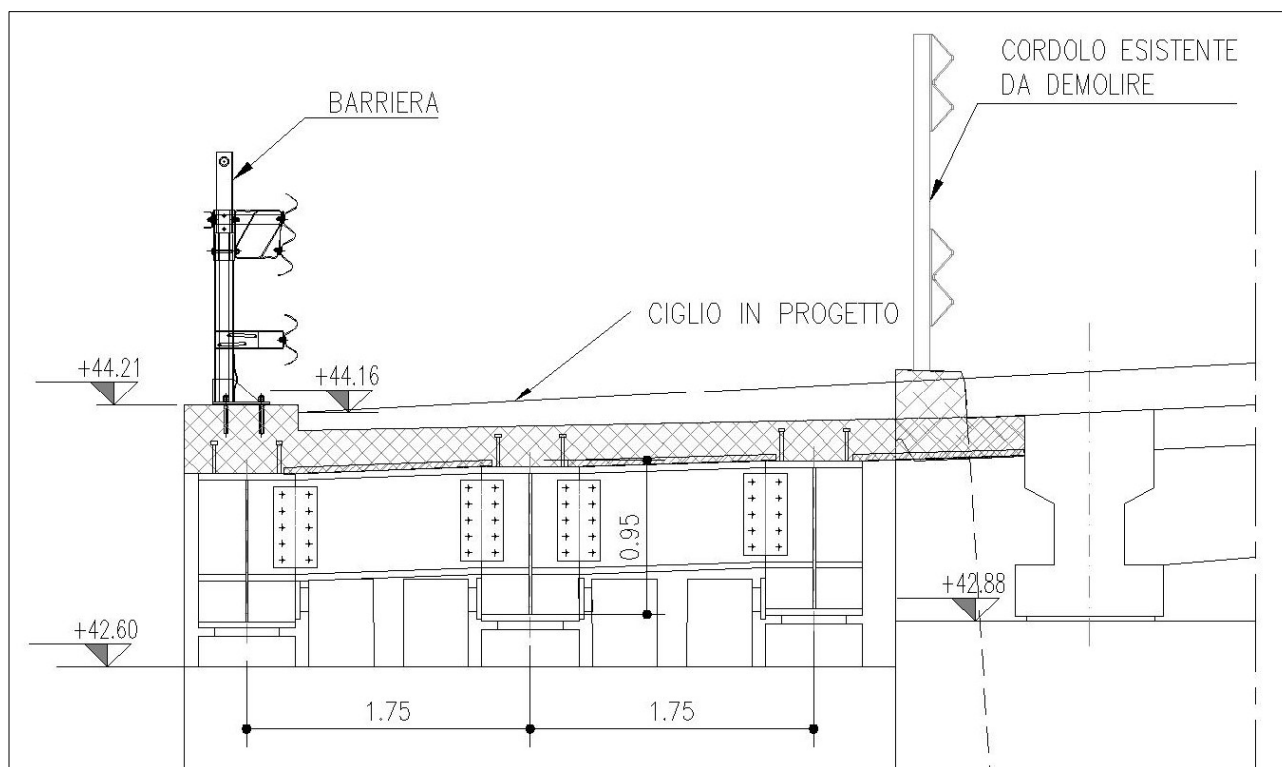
Sezione longitudinale trave in ampliamento – Lato Sud
